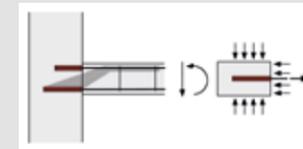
Eingemörtelte Stäbe im Bereich von Endauflagern
